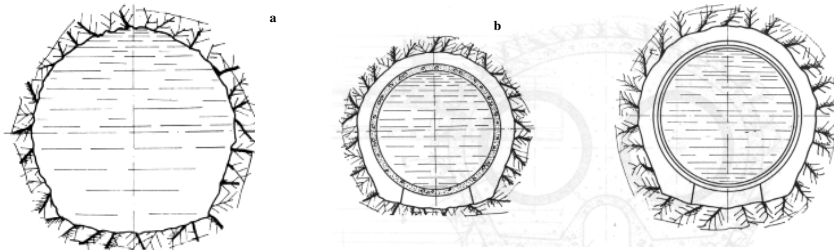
a - galería de presión enclavada en la roca, b- galería de presión con revestimiento de H²A°, c- galería de presión con revestimiento de chapa de acero laminado.
